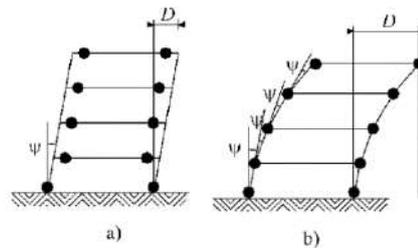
Le principe « poteaux forts – poutres faibles »
